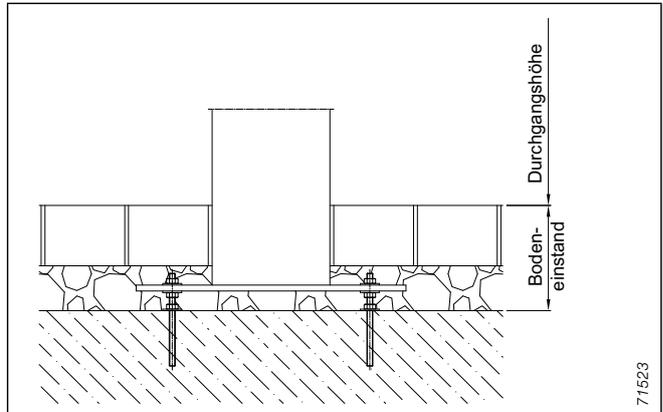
Befestigung auf Betonfundament (mit Distanz)
